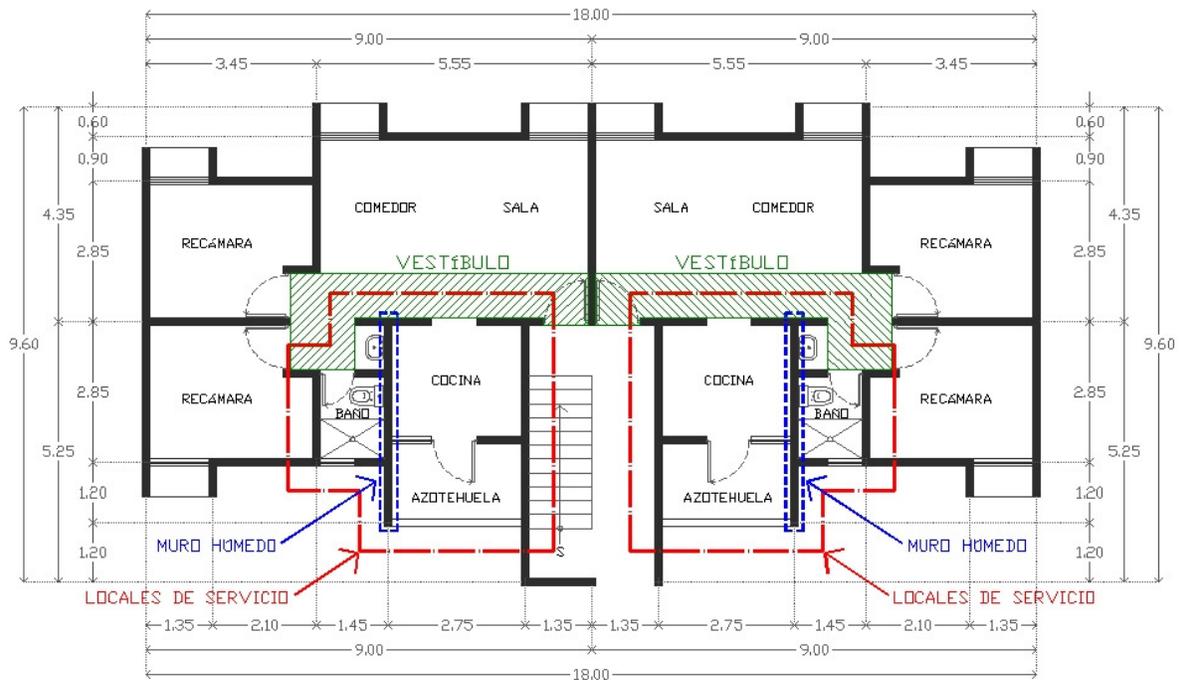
Planta arquitectónica del prototipo M-1 del FOVISSSTE. Fuente: elaboración propia con base en Boils (1995:35).
